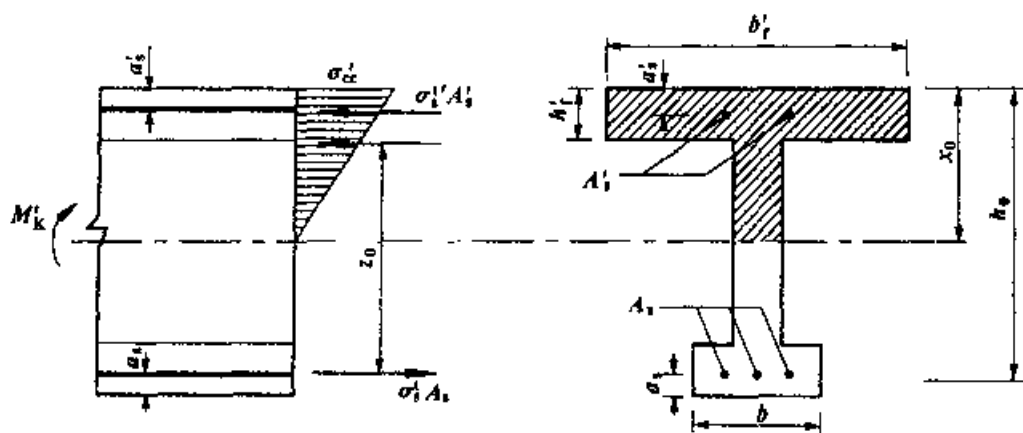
钢筋混凝土受弯构件正截面应力计算
